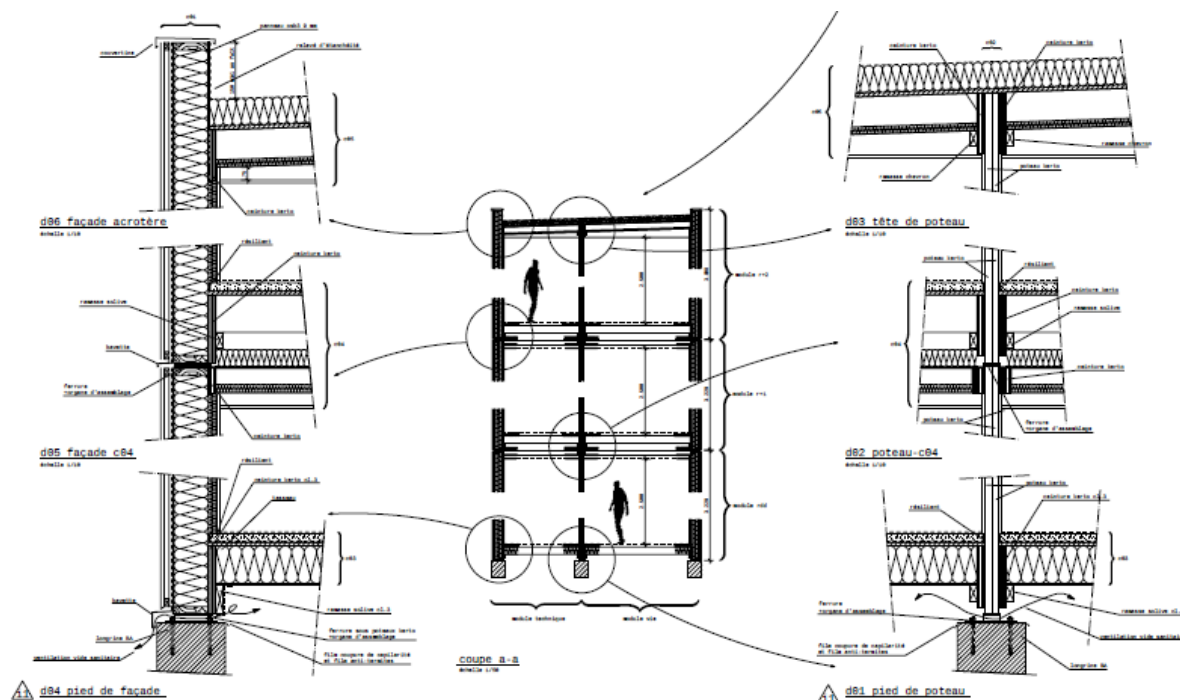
coupe de principe de structure en phase d'études préliminaires – BET Sylva Conseils
